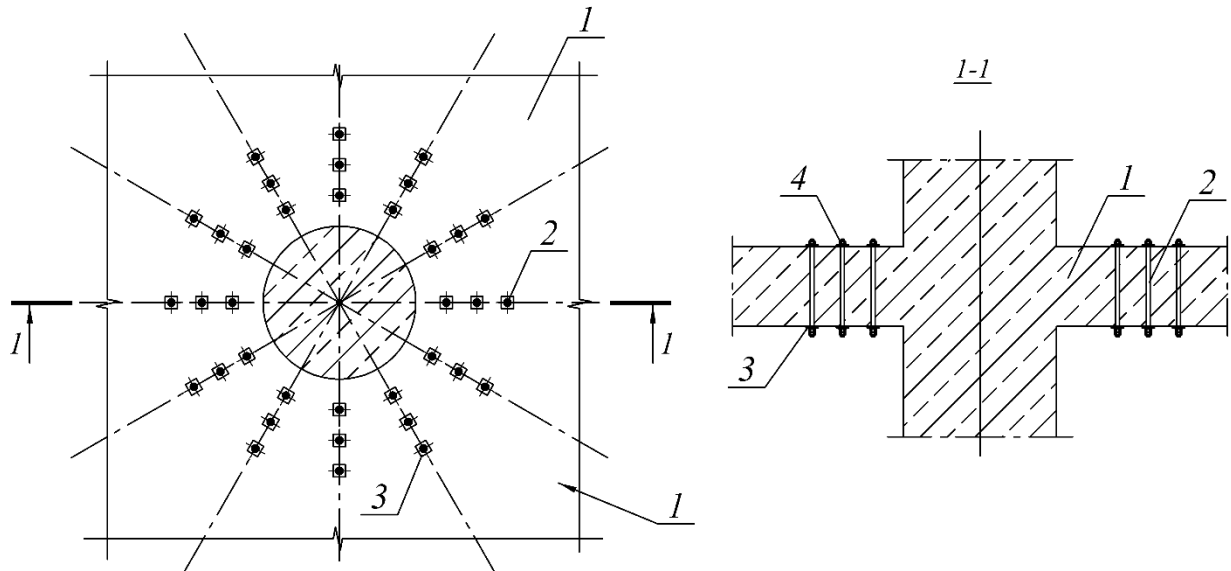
Усиление плоских плит на восприятие поперечных сил поперечными шпильками
